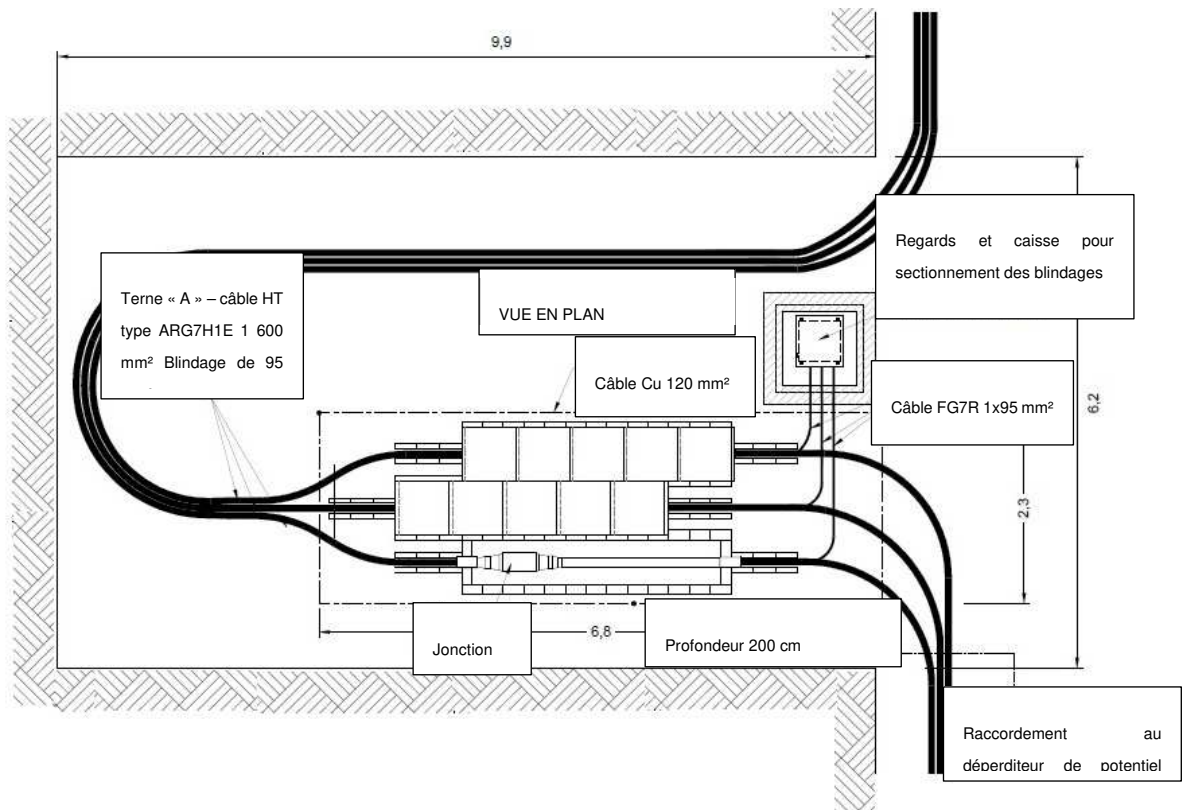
Chambre de jonction en tunnel (vue en plan)
